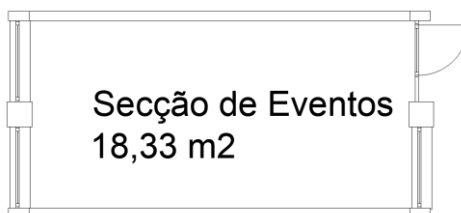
Planta em 2D da secção de eventos da AE ISEC.
